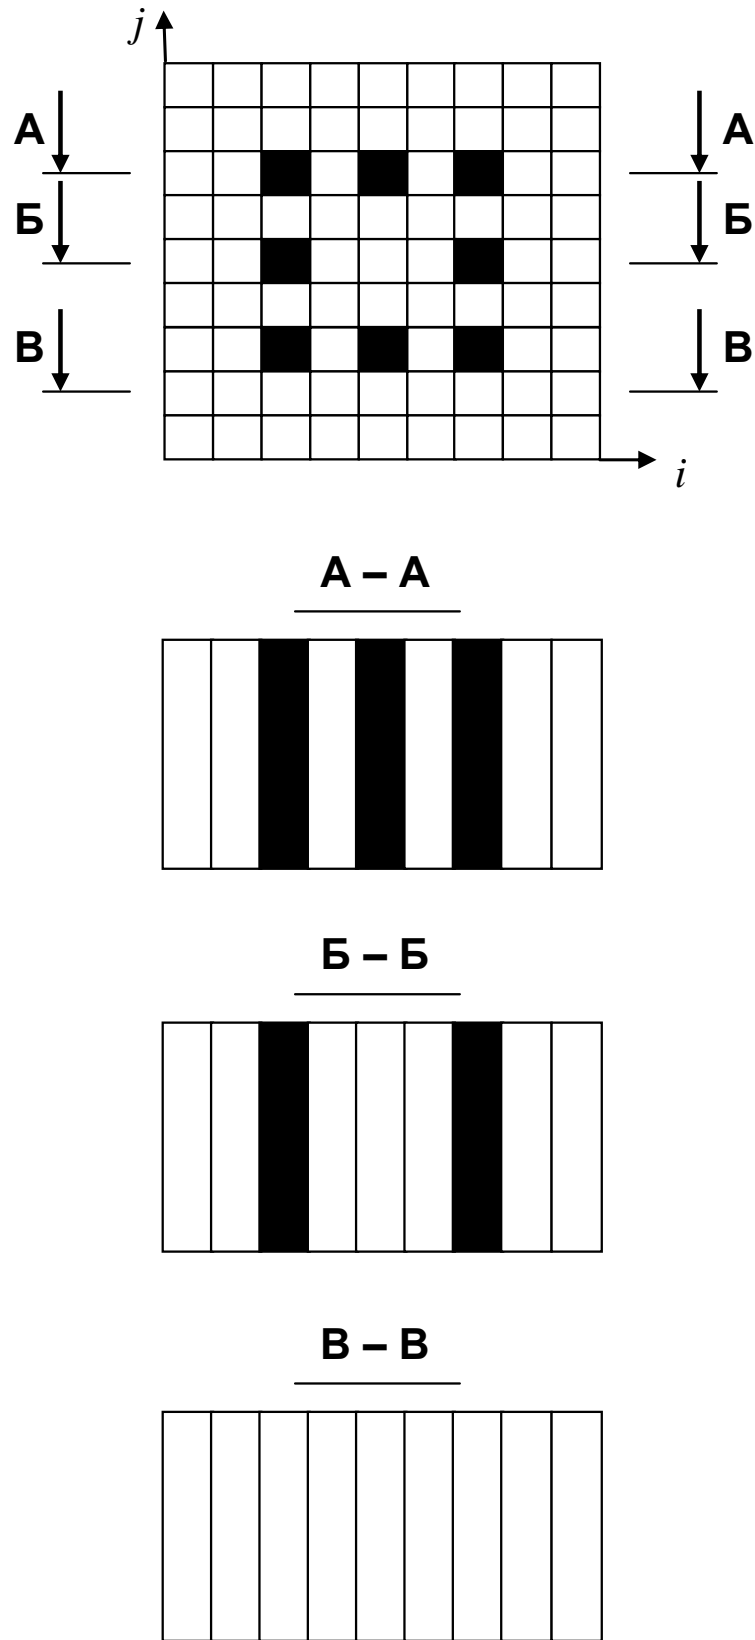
Перетин залізобетонної балки, що містить вісім арматурних прутів, розділений на плоскі елементи:
